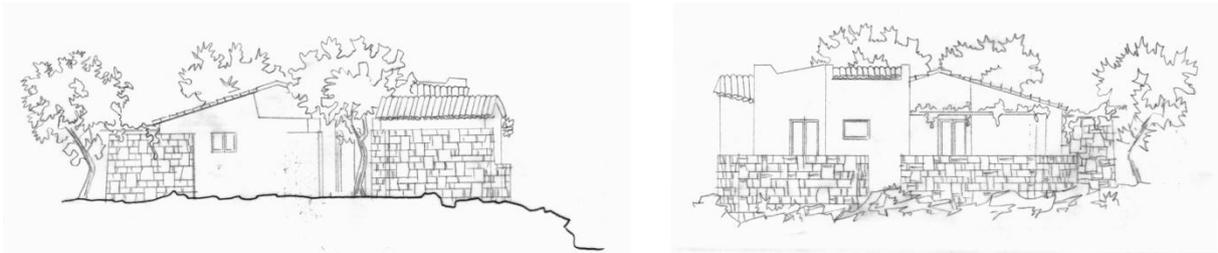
Piccole aperture caratterizzano i prospetti di tutte le casette. Da sinistra: prospetto A e prospetto C del gruppo di casette E.
